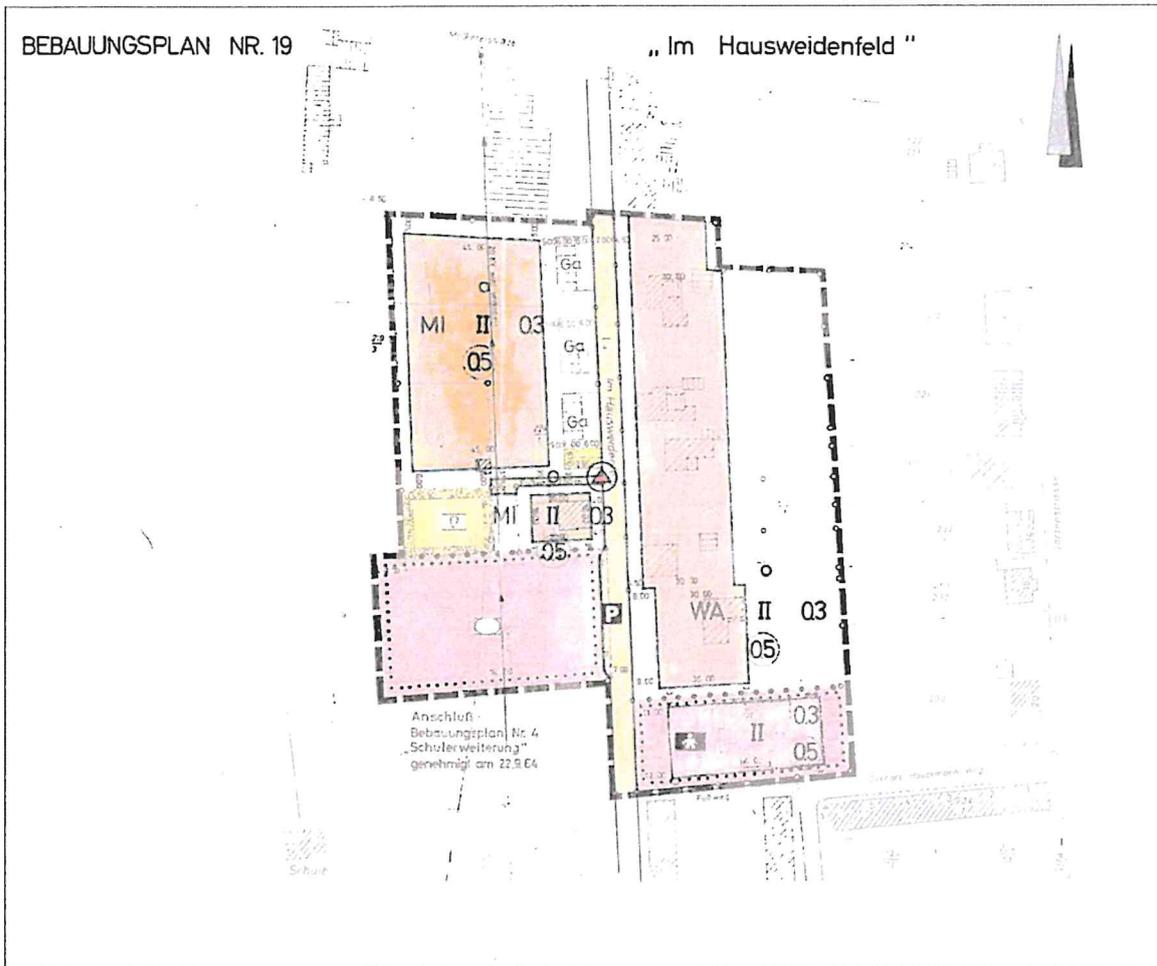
1. Bebauungsplan Nr. 19 in Lauenau (unmaßstäbliche Darstellung)
